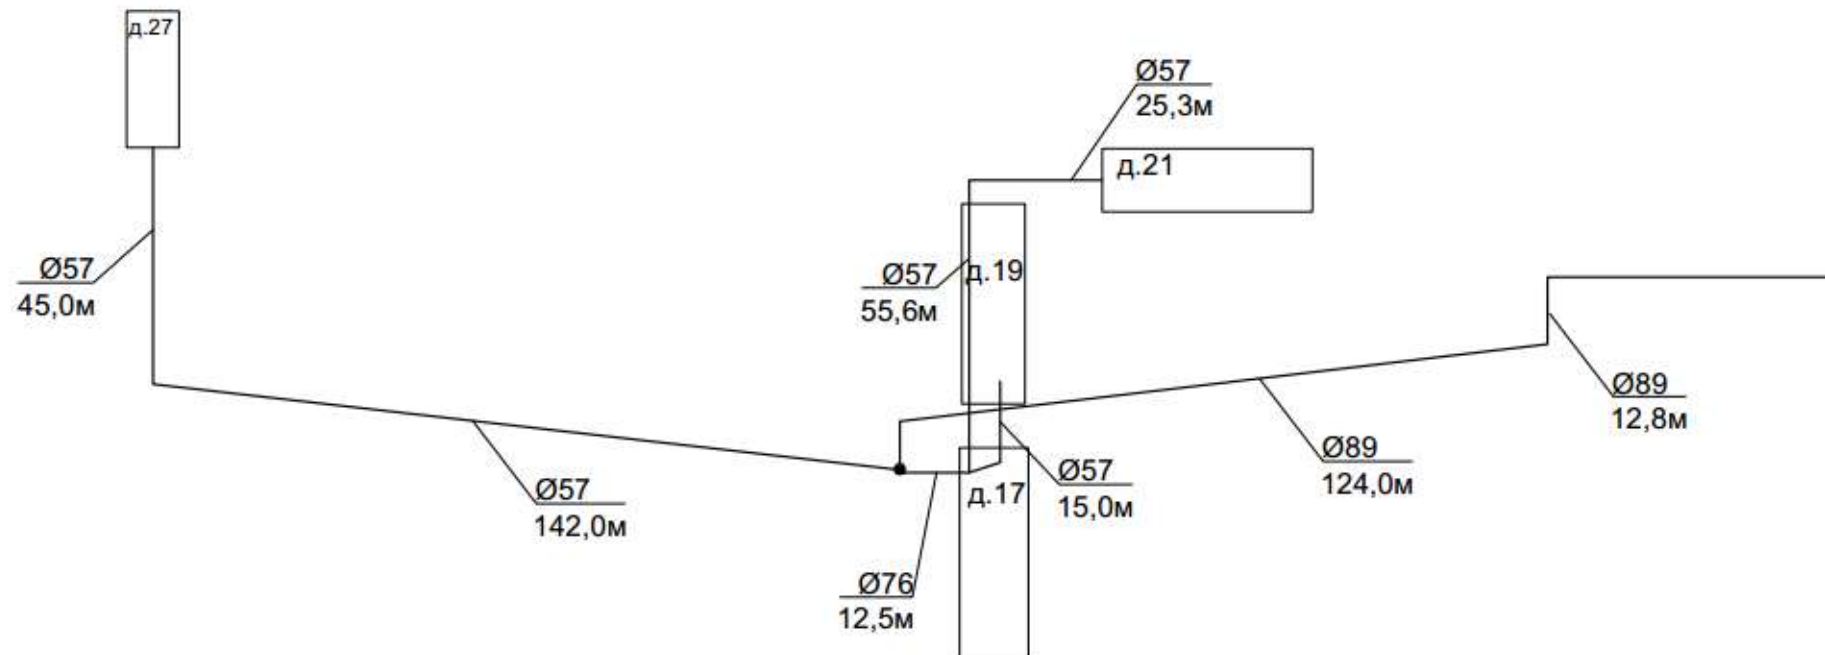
Схема тепловой сети котельной ПМК-2 (лист1)
